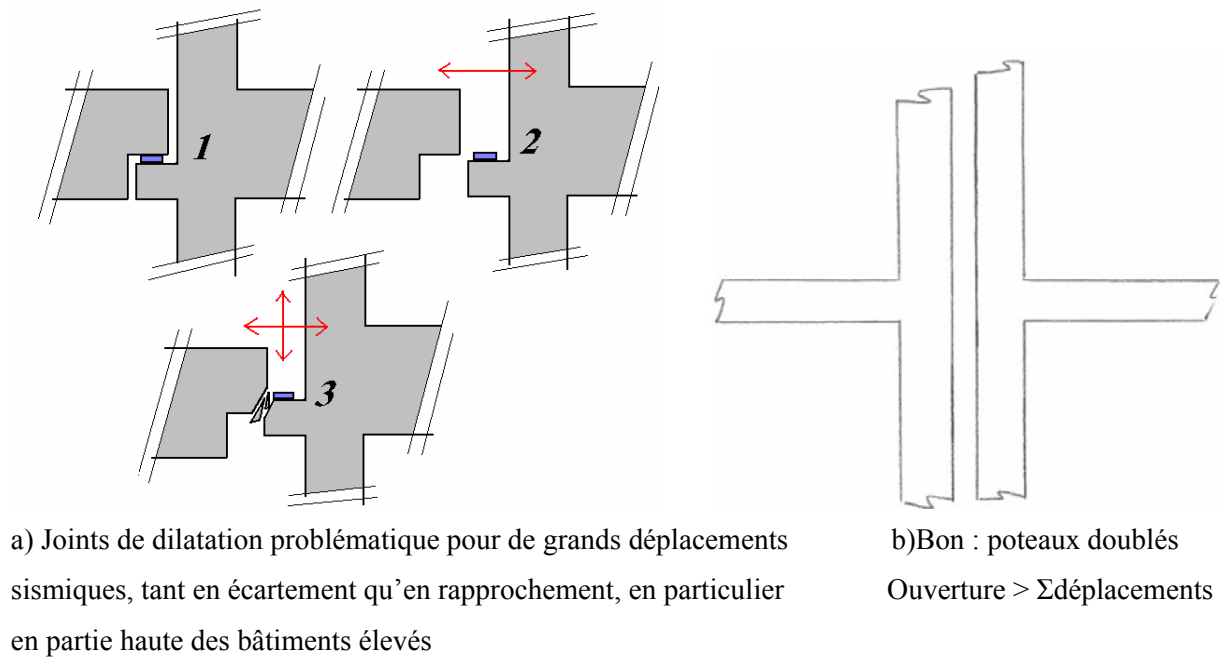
Détails de joints entre bâtiments ou entre blocs constituant un bâtiment.
